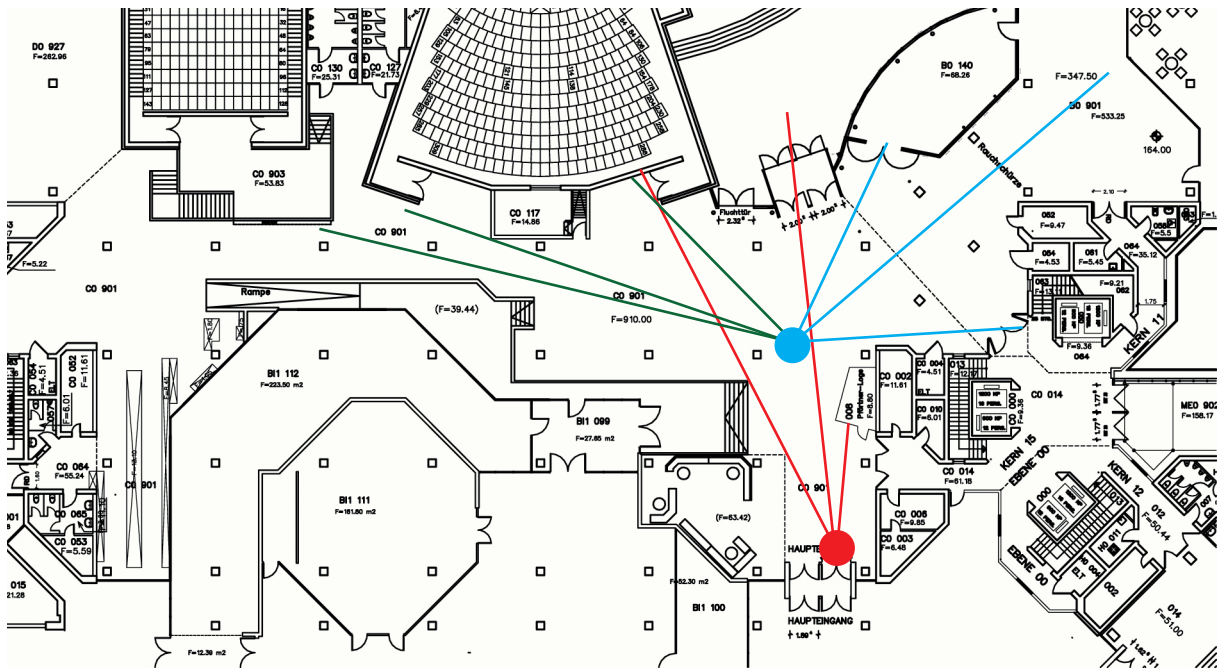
Grundriss des Foyers mit eingezeichneten Blickachsen. Der rote Punkt stellt den Beobachtungspunkt vom Haupteingang dar, der blaue Punkt den Beobachtungspunkt, den der Nutzer einnimmt, wenn er hinter dem Bibliotheksaufgang steht und den Quergang erreicht hat. An dieser Skizze wird deutlich, dass die meisten Eingänge für den Nutzer nicht sichtbar sind.
